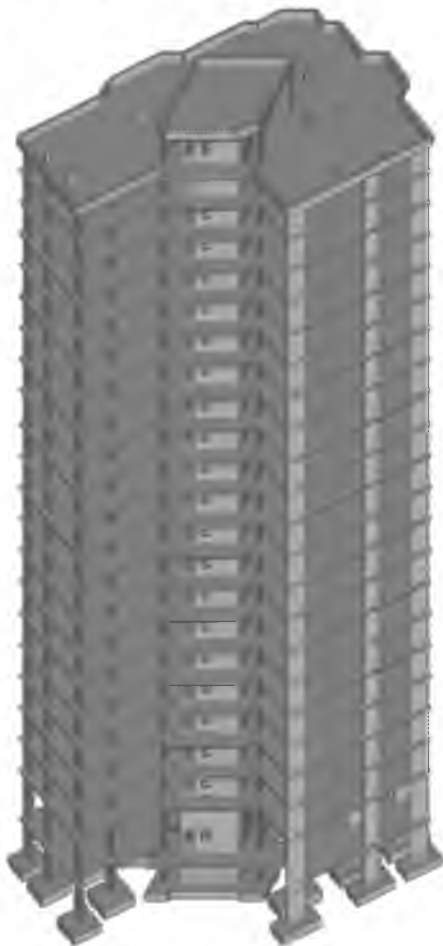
3D модель каркасу будівлі Рис. 3.2. Розрахункова схема каркасу будівлі
